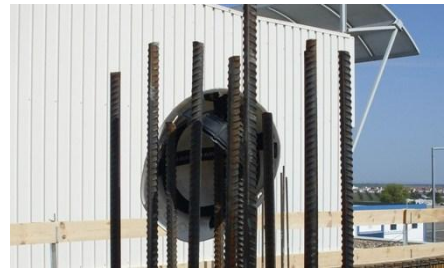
Capacete de Segurança preso nas armaduras de um pilar
